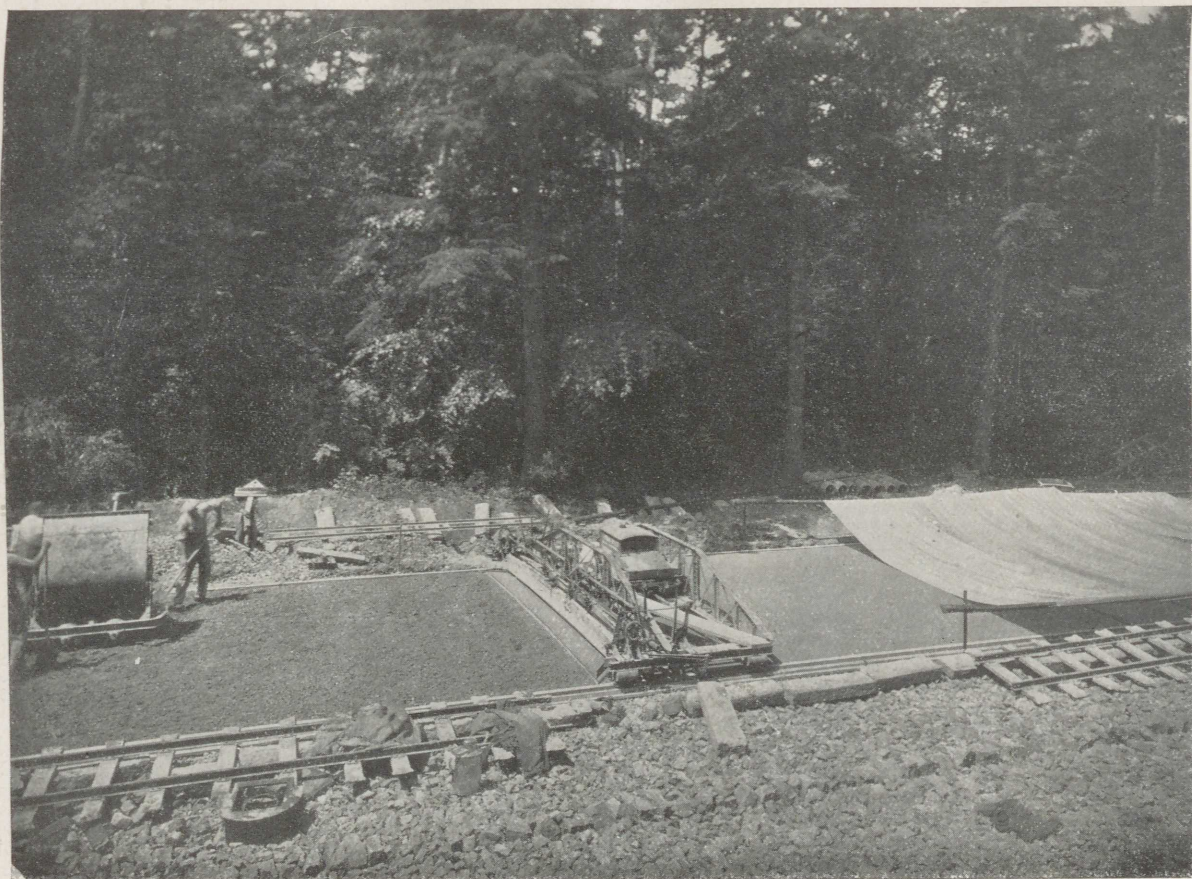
Stuttgart, Jahnstraße (Geroksrufe-Stelle). Ausf.: Ludw. Bauer, Stuttgart
